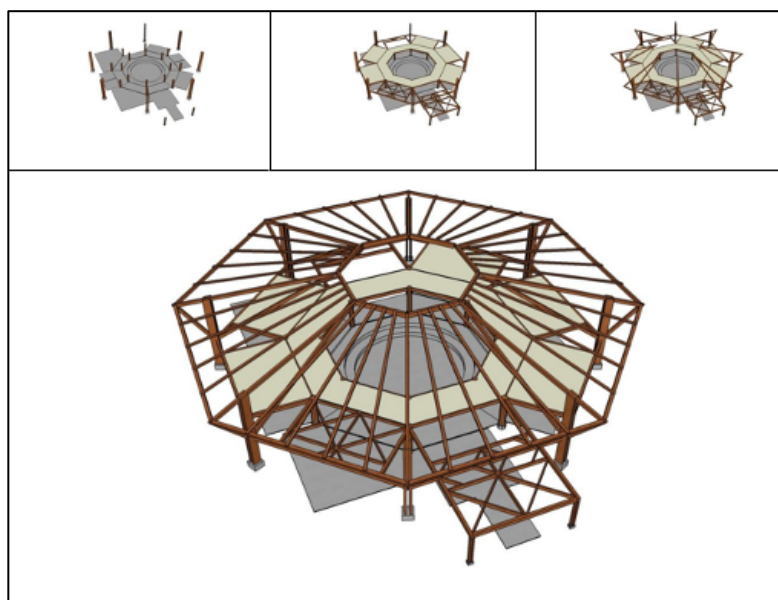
Sequência construtiva – projeto estrutural proposto. Fonte: CEPLAN.
